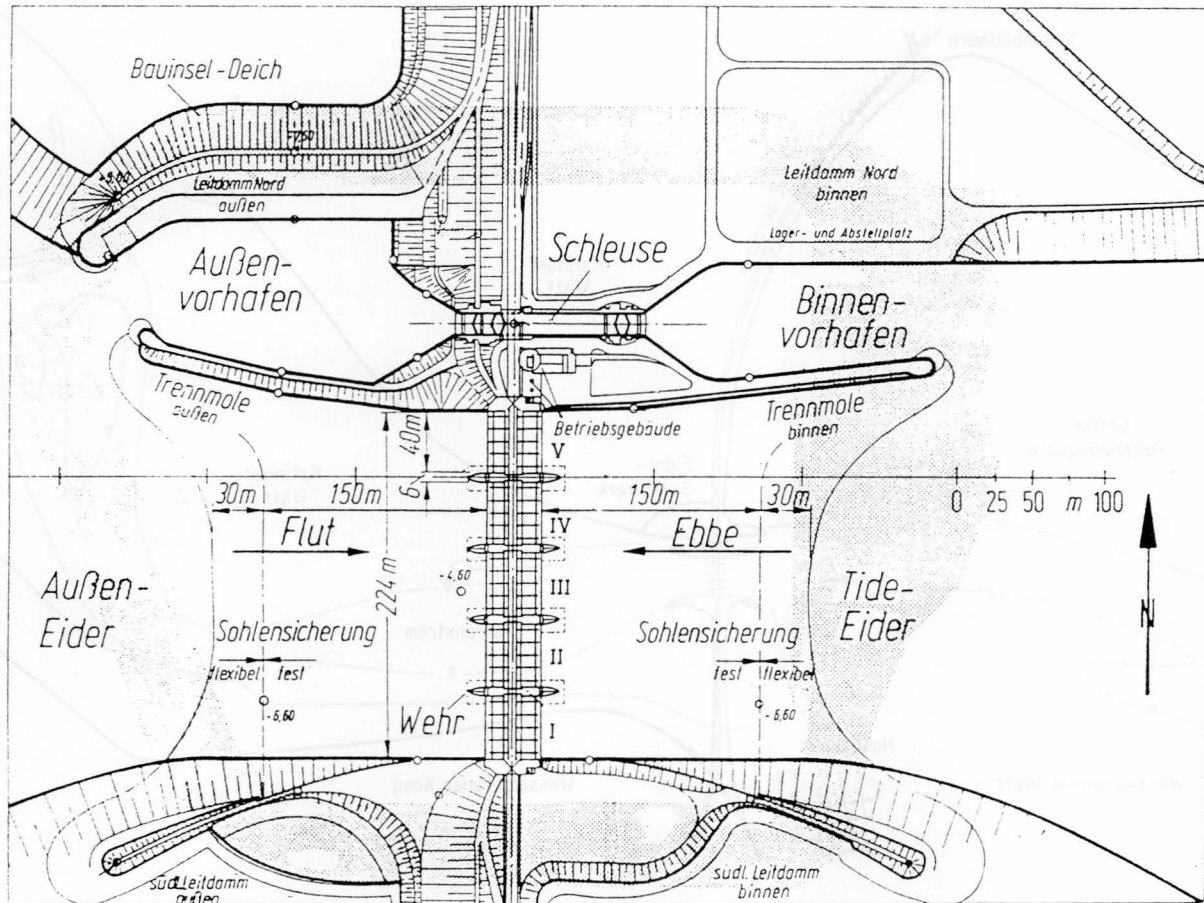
Lageplan Eider-Sperrwerk mit Wehr, Schleuse und Vorhäfen
